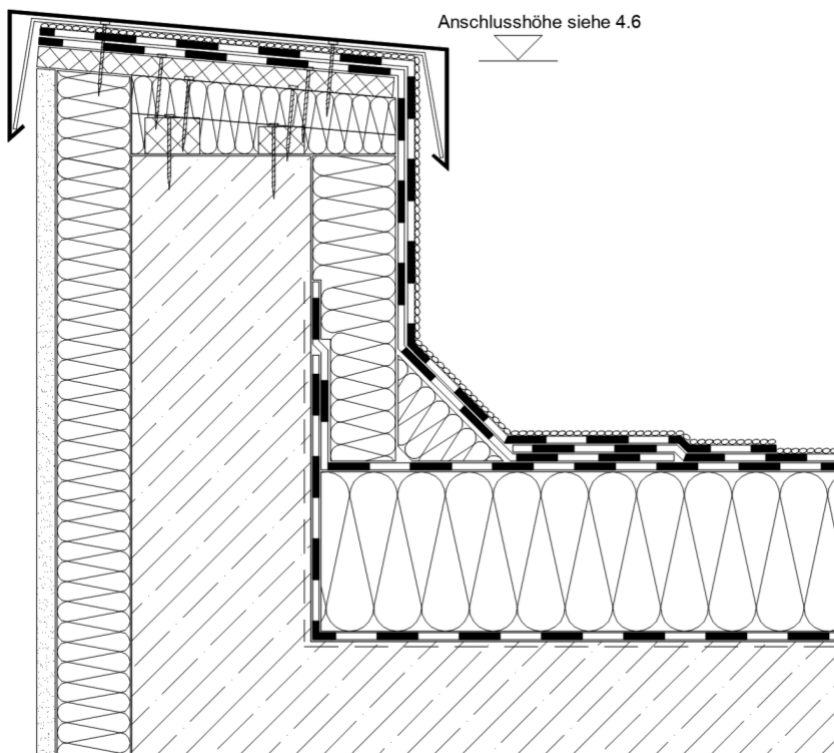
Starrer Dachrandabschluss – Ausführung mit Bitumenbahnen für einlagige Verlegung
